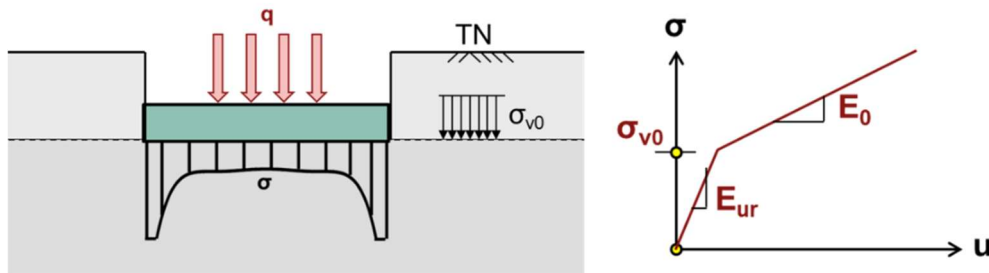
Traitement d'un radier fondé au fond d'une excavation
